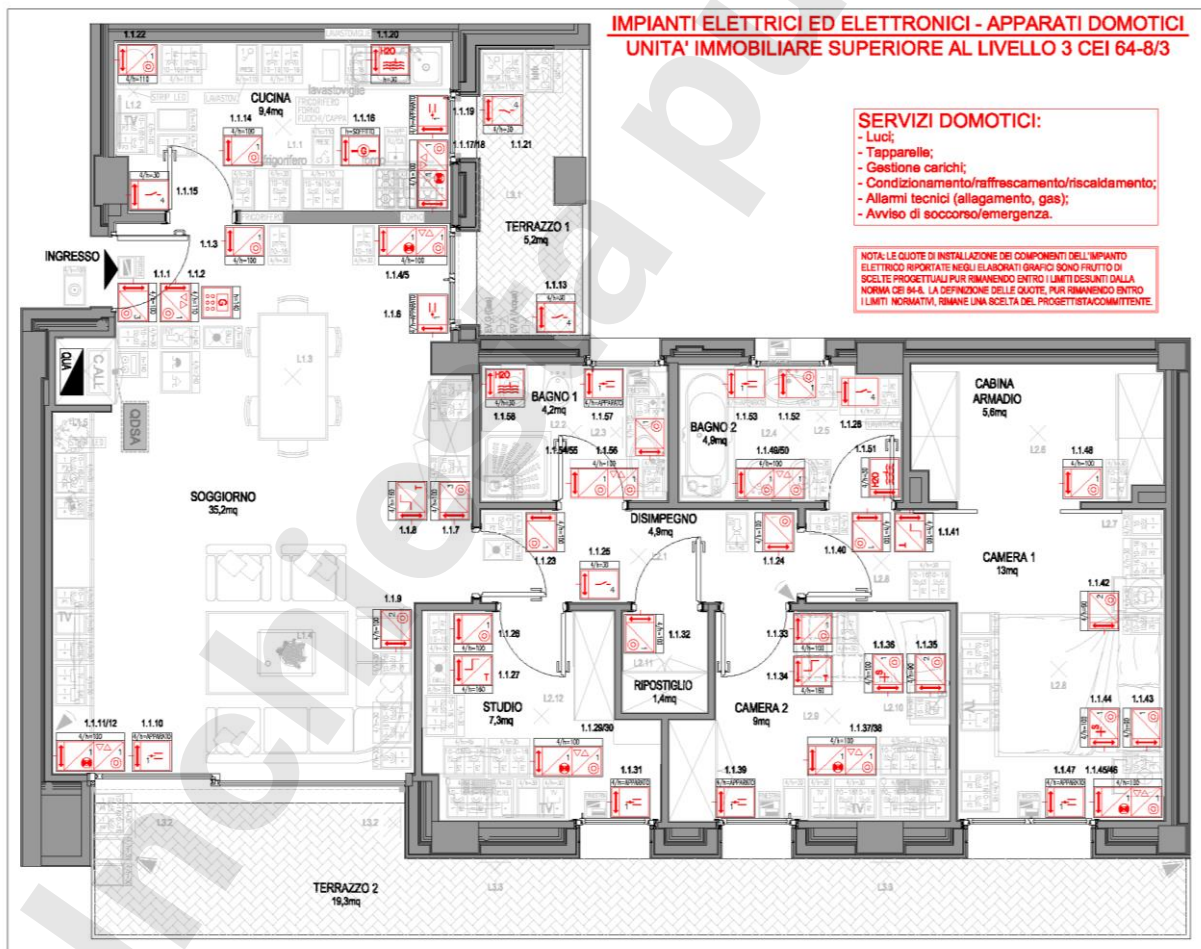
Schema planimetrico d'installazione (piano terra)
